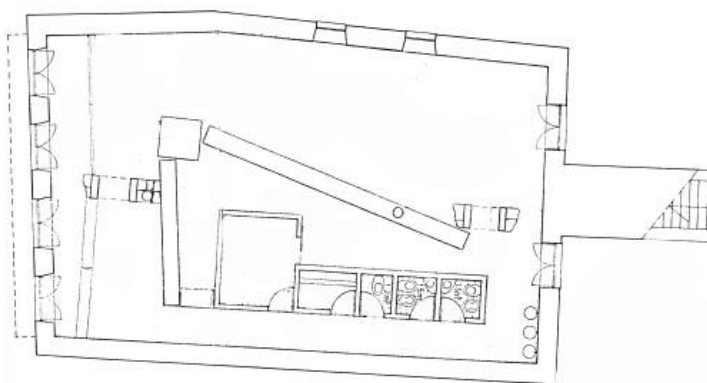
Planta da proposta -Esc. 1/200 – Autor do projeto
